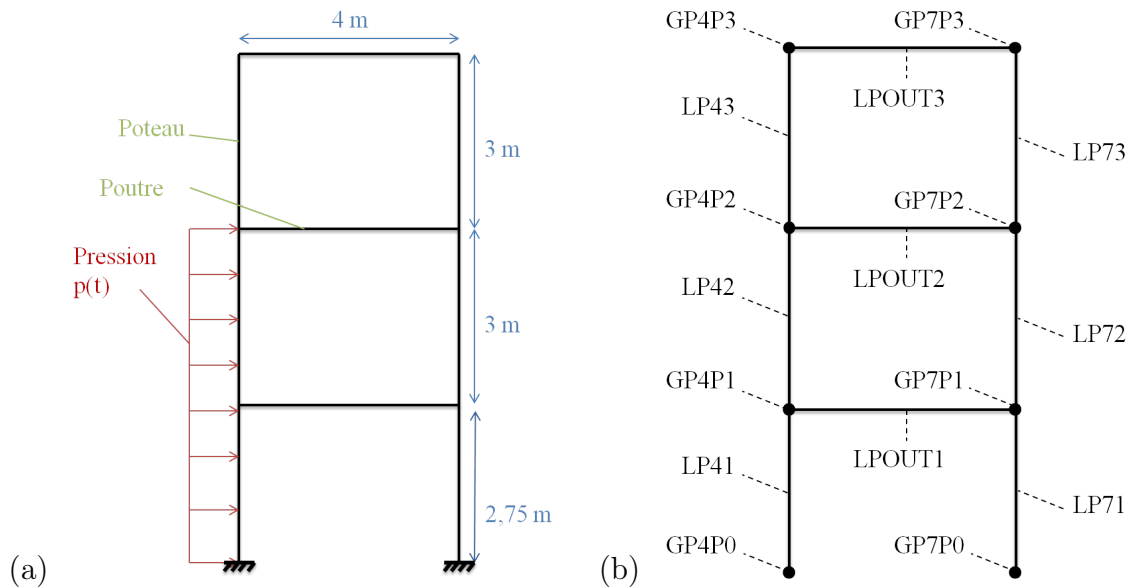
Structure poteaux-poutres considérée : (a) dimensions et (b) modèle numérique (Tataie, 2011)
